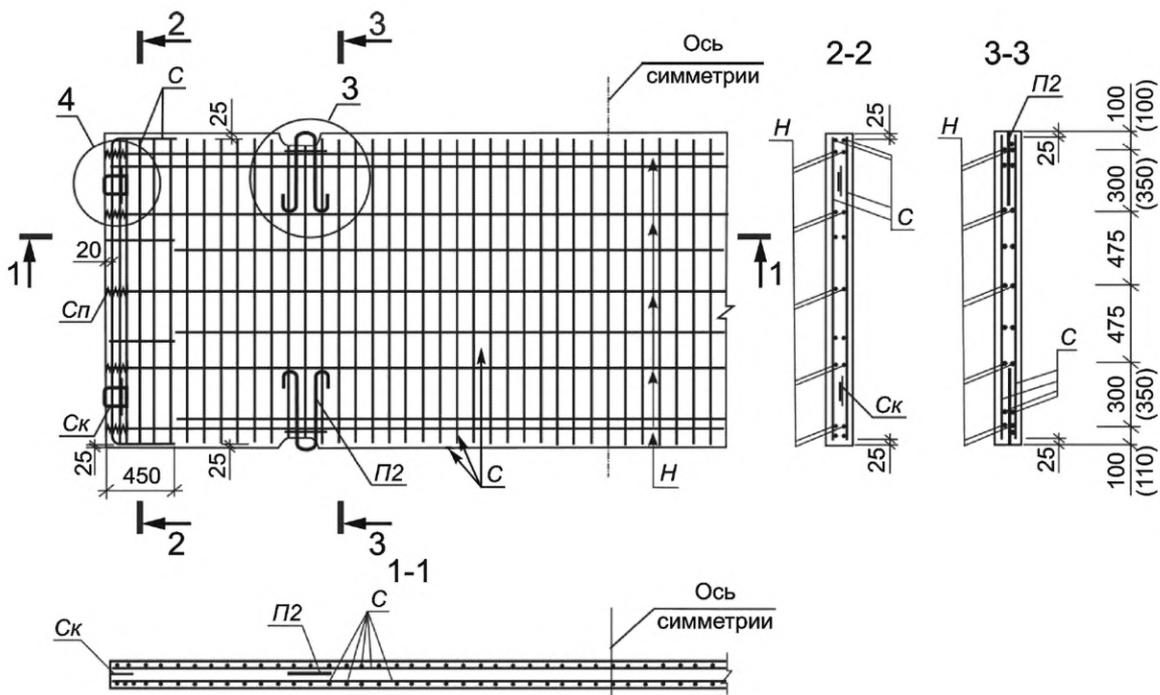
Схемы армирования плит П60.19, П60.18
